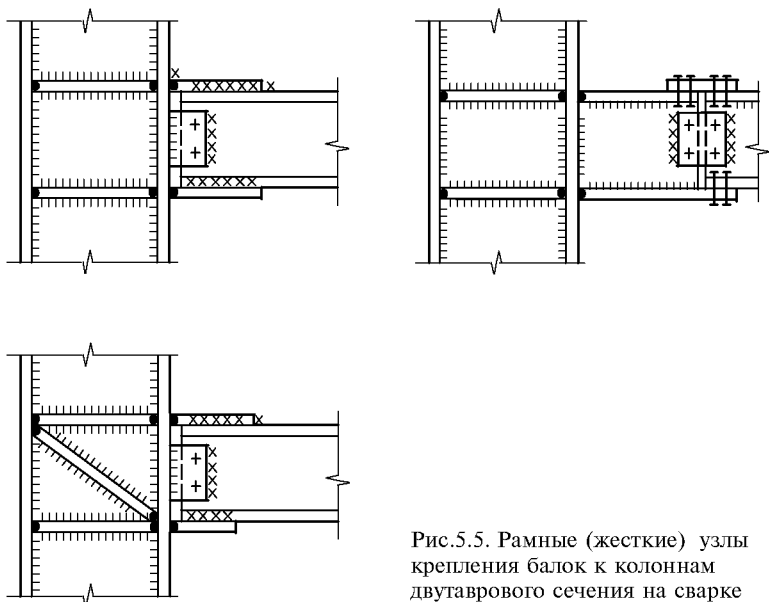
Рамные (жесткие) узлы крепления балок к колоннам двутаврового сечения на сварке
